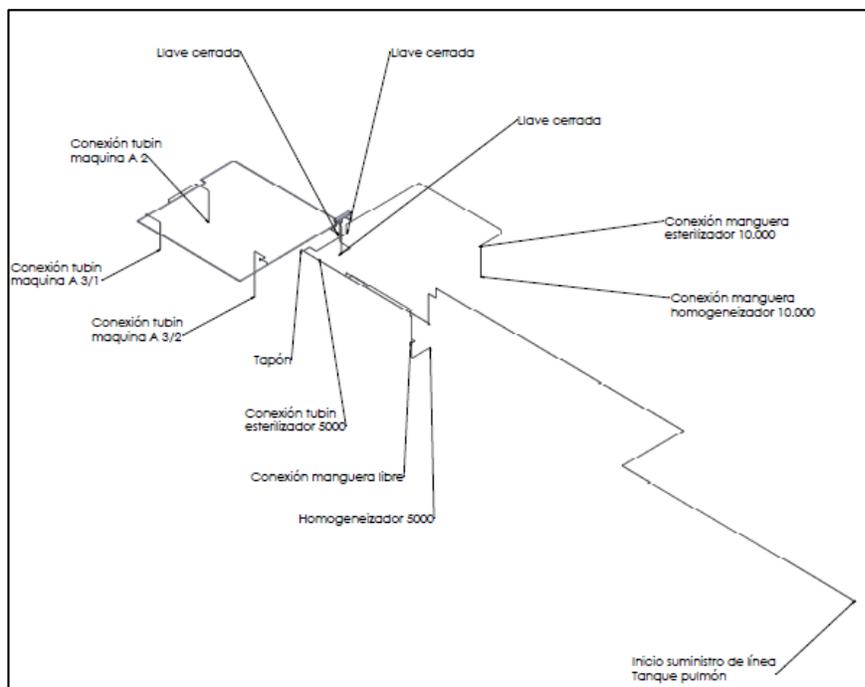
Plano tubería de aire área UHT. Fuente. Autor
